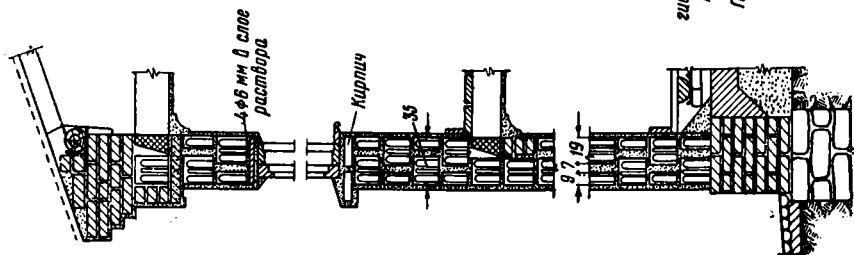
Кладка из керамических камней с облицовкой кирпичом
